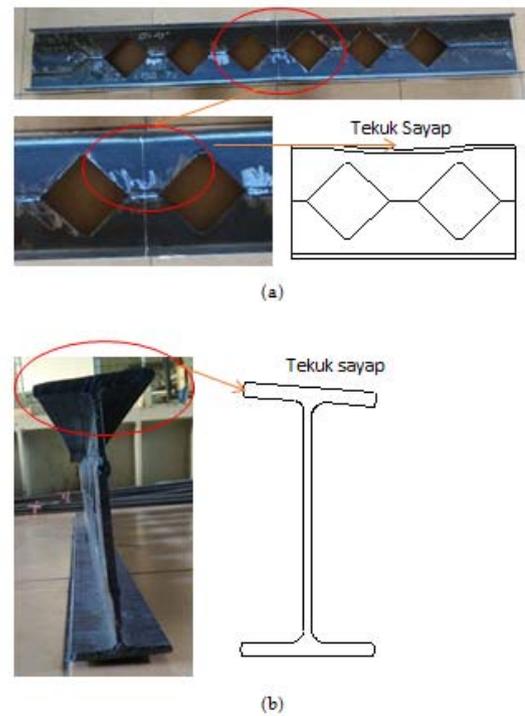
Pola runtuh benda uji 2 ($\varnothing=60^\circ$) setelah pengujian (a) pada tengah bentang; (b) tampak samping
